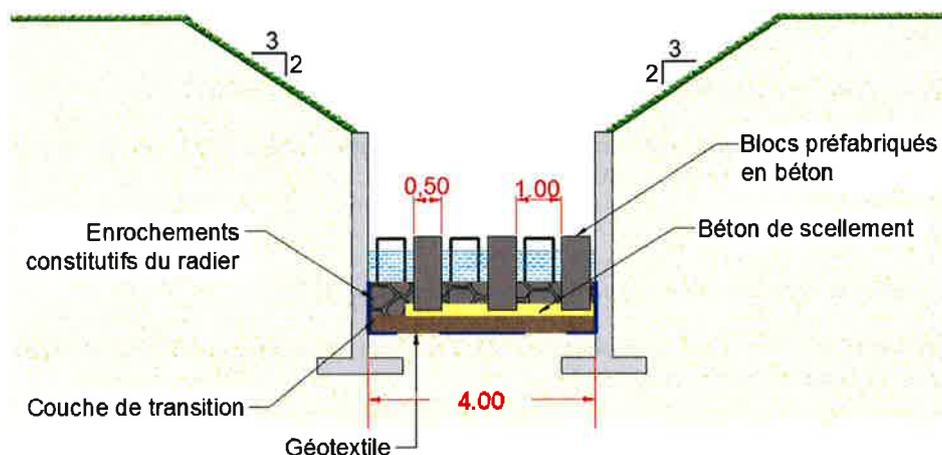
Coupe de principe de la rampe à macrorugosités régulièrement réparties
